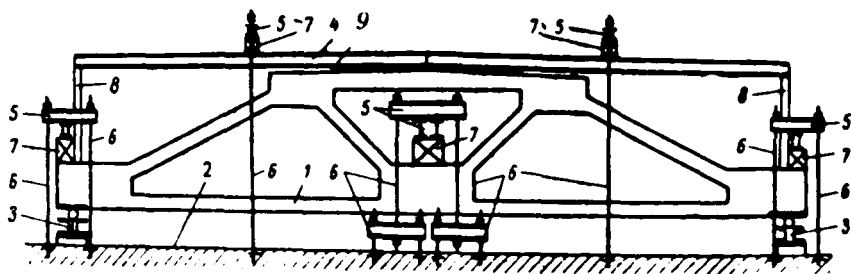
Схема испытания подстропильной фермы серии ПК-01-110
